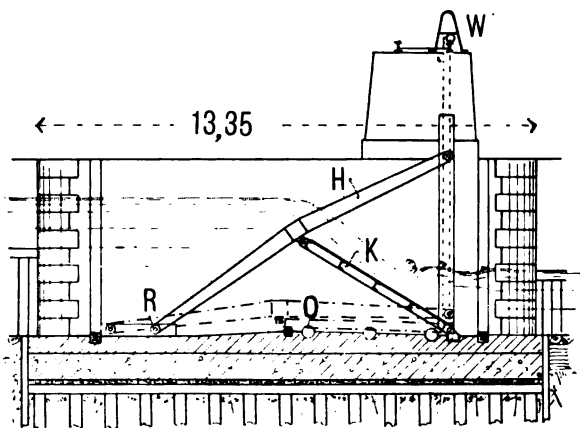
Hebelklappe, Schiffsdurchlaß mit Klappenverschluß bei Große Tränke in der Spree.
